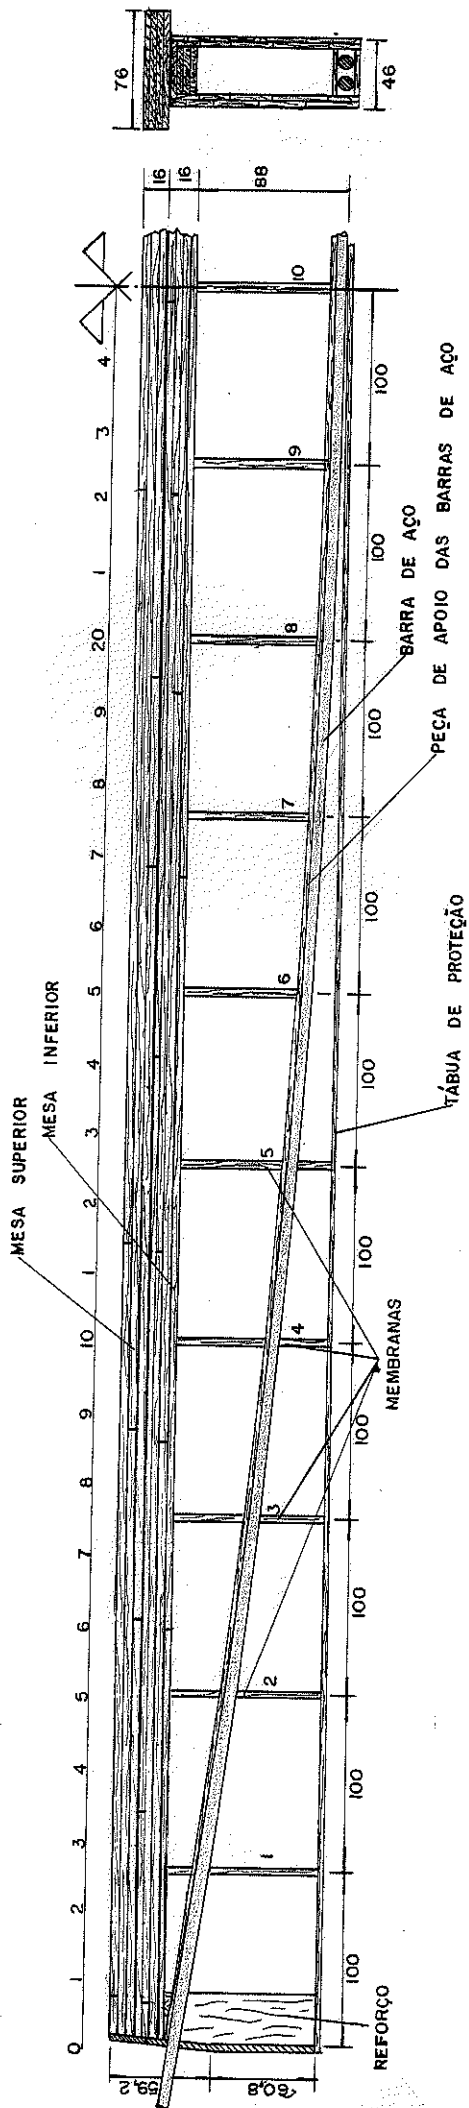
SEÇÃO LONGITUDINAL DA VIGA DO PROTÓTIPO
